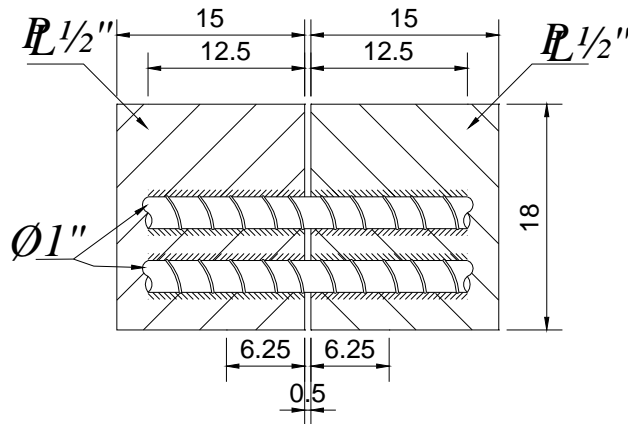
Detalles de barras ϕ 2.54 cm soldadas a placas (dimensiones en cm)
